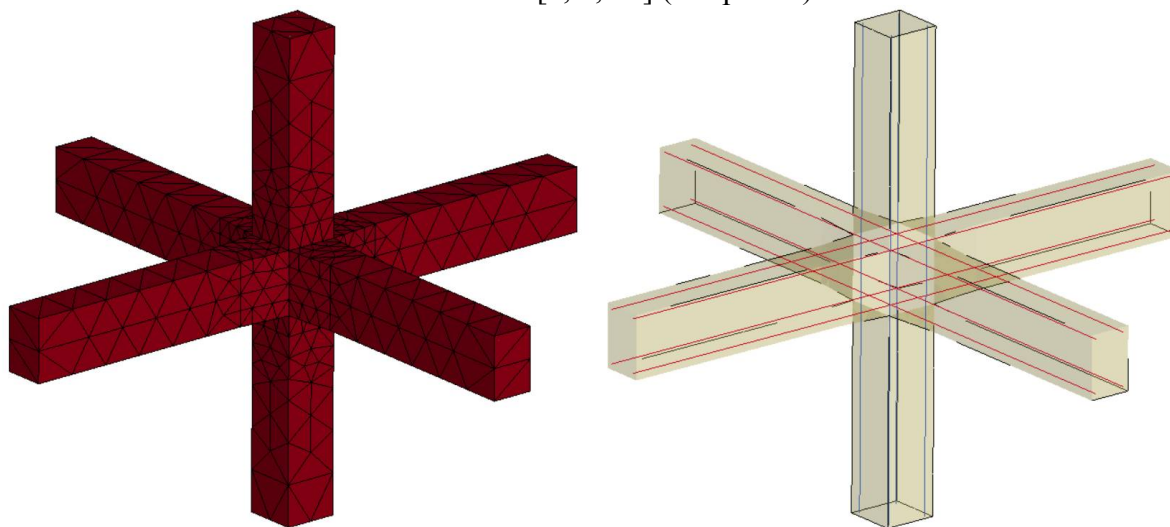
Общий вид конструкции узла каркаса и конструктивная схема
